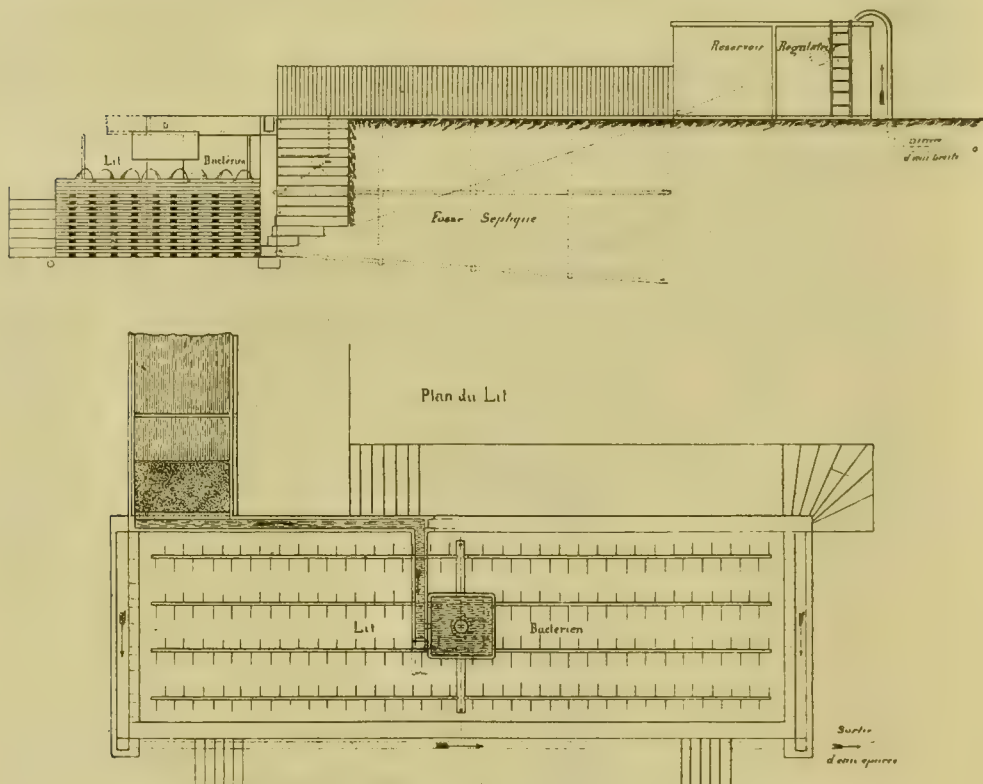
Station d'épuration d'Hardelot (plan et coupe d'une unité).
